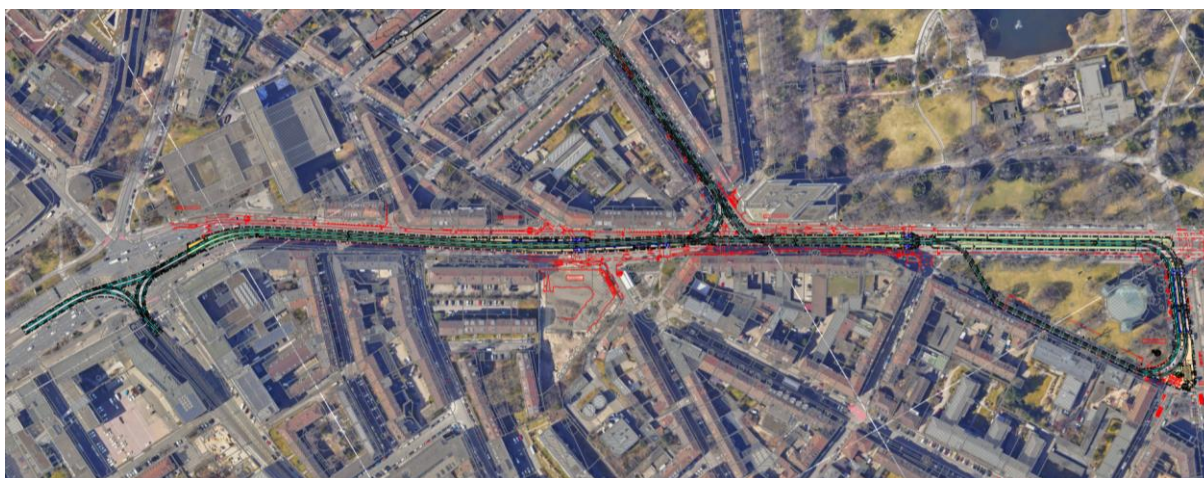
Übersichtslageplan mit Luftbild (Unterlage 03.1)
